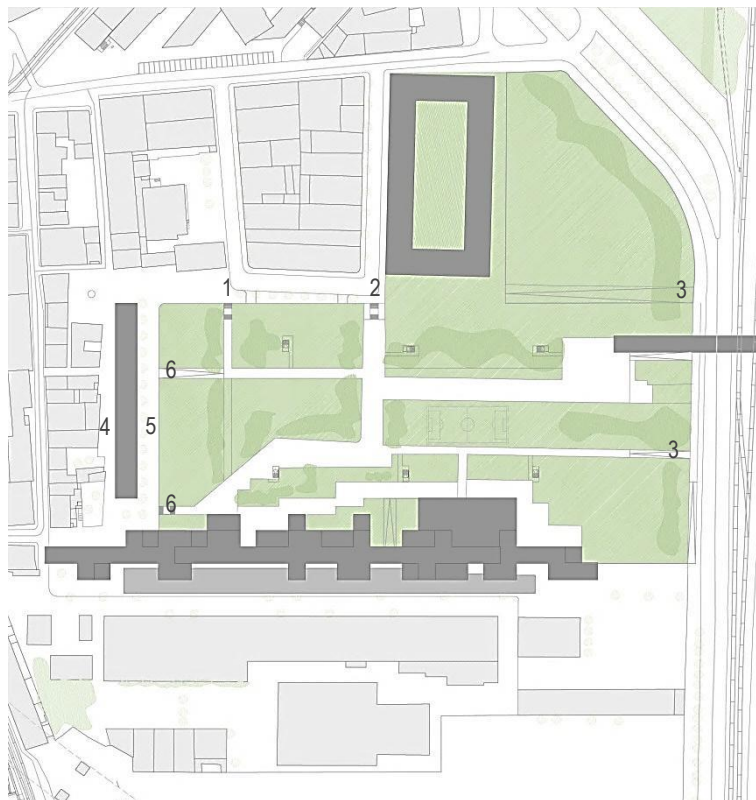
Planta zona de intervenção, acessos ao jardim urbano.
